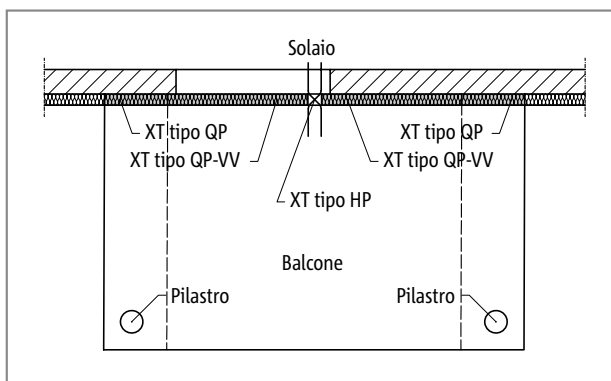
Schöck Isokorb® XT tipo QP, QL-VV: balcone con appoggio su pilastri con diverse rigidzze del punto di vincolo; opzionale con XT tipo HP per il trasferimento della forza orizzontale di progetto
